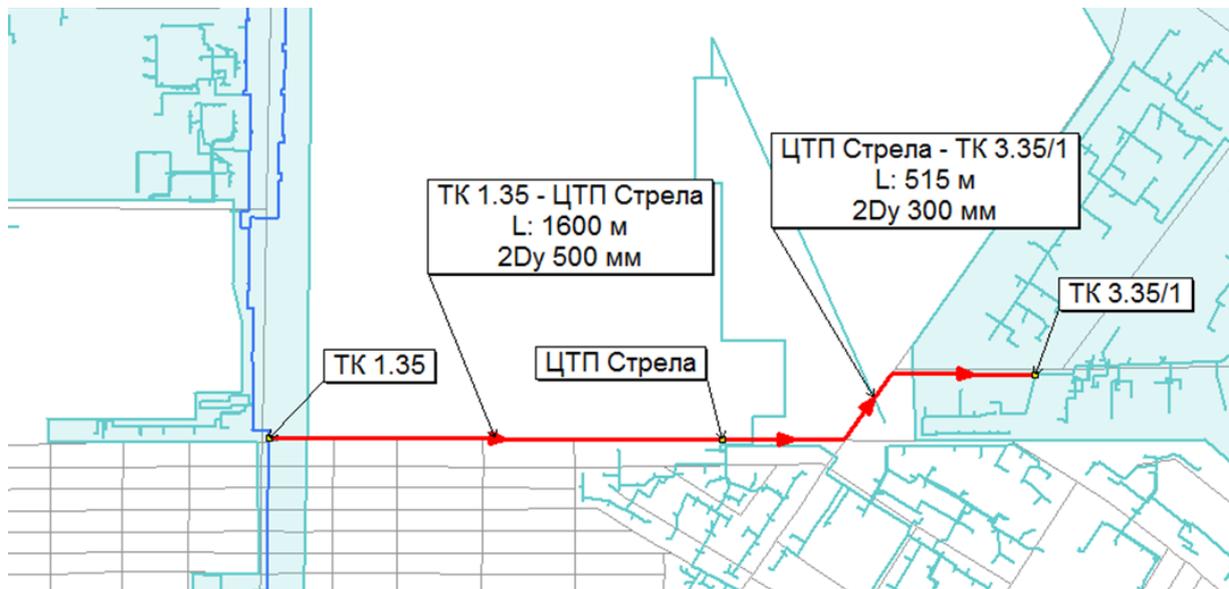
Схема трубопроводов для переключения тепловой нагрузки котельных «Уральская» и «Чкалова» на Сакмарскую ТЭЦ
